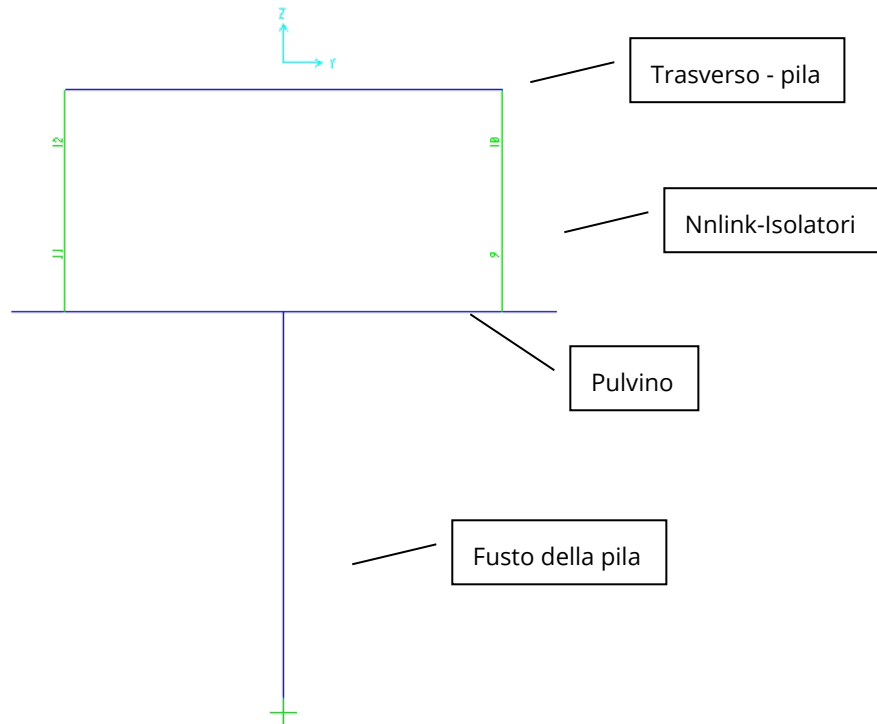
Modellazione pila e pulvino con elementi *frame* e link di collegamento con l'impalcato
